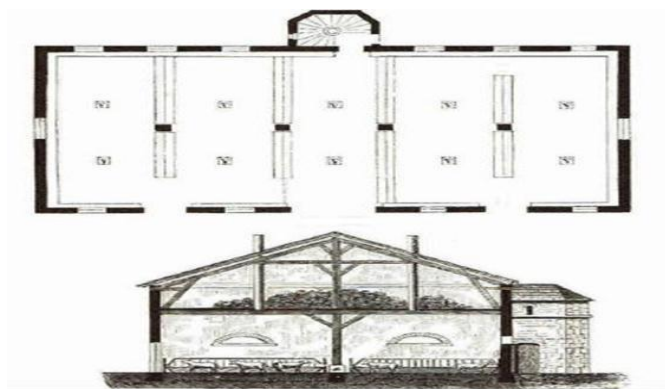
Plan et coupe d'une bergerie. Source: Bouchard-Huzard, Louis. Traité des constructions rurales. Ed 1, 1982, P.169
